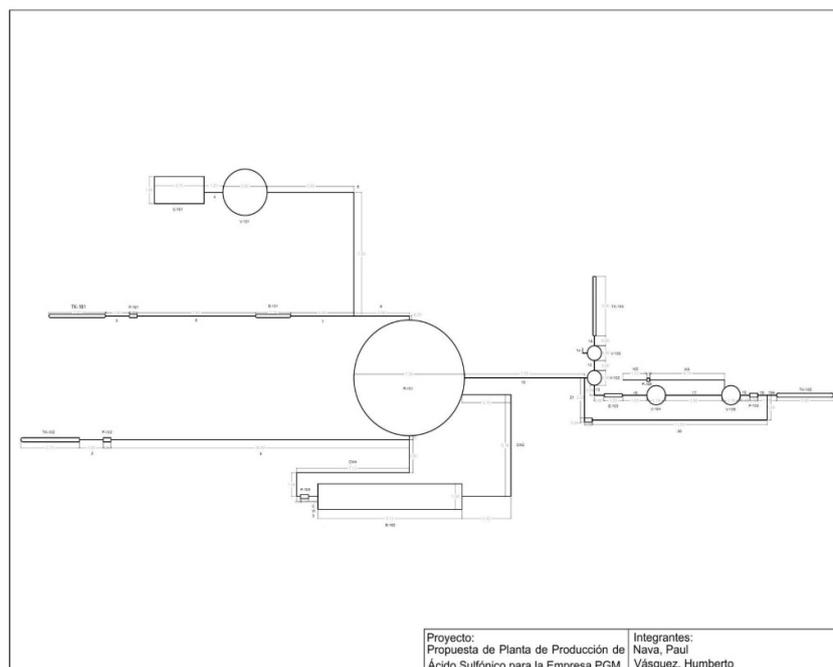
Layout de la Planta de Producción de Ácido Sulfónico [7]
